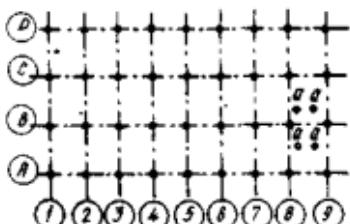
Сетка фундаментов однотажного промышленного здания.
